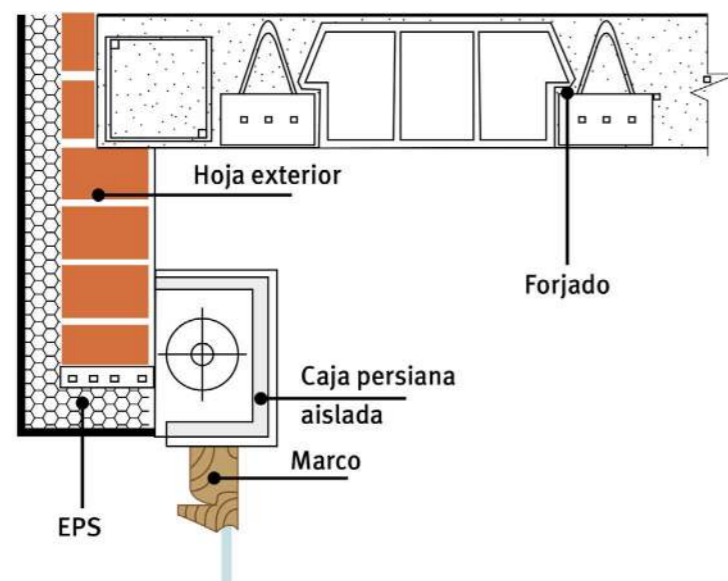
Detalle 1. Sistema SATE. Encuentro de fachada con dintel.
